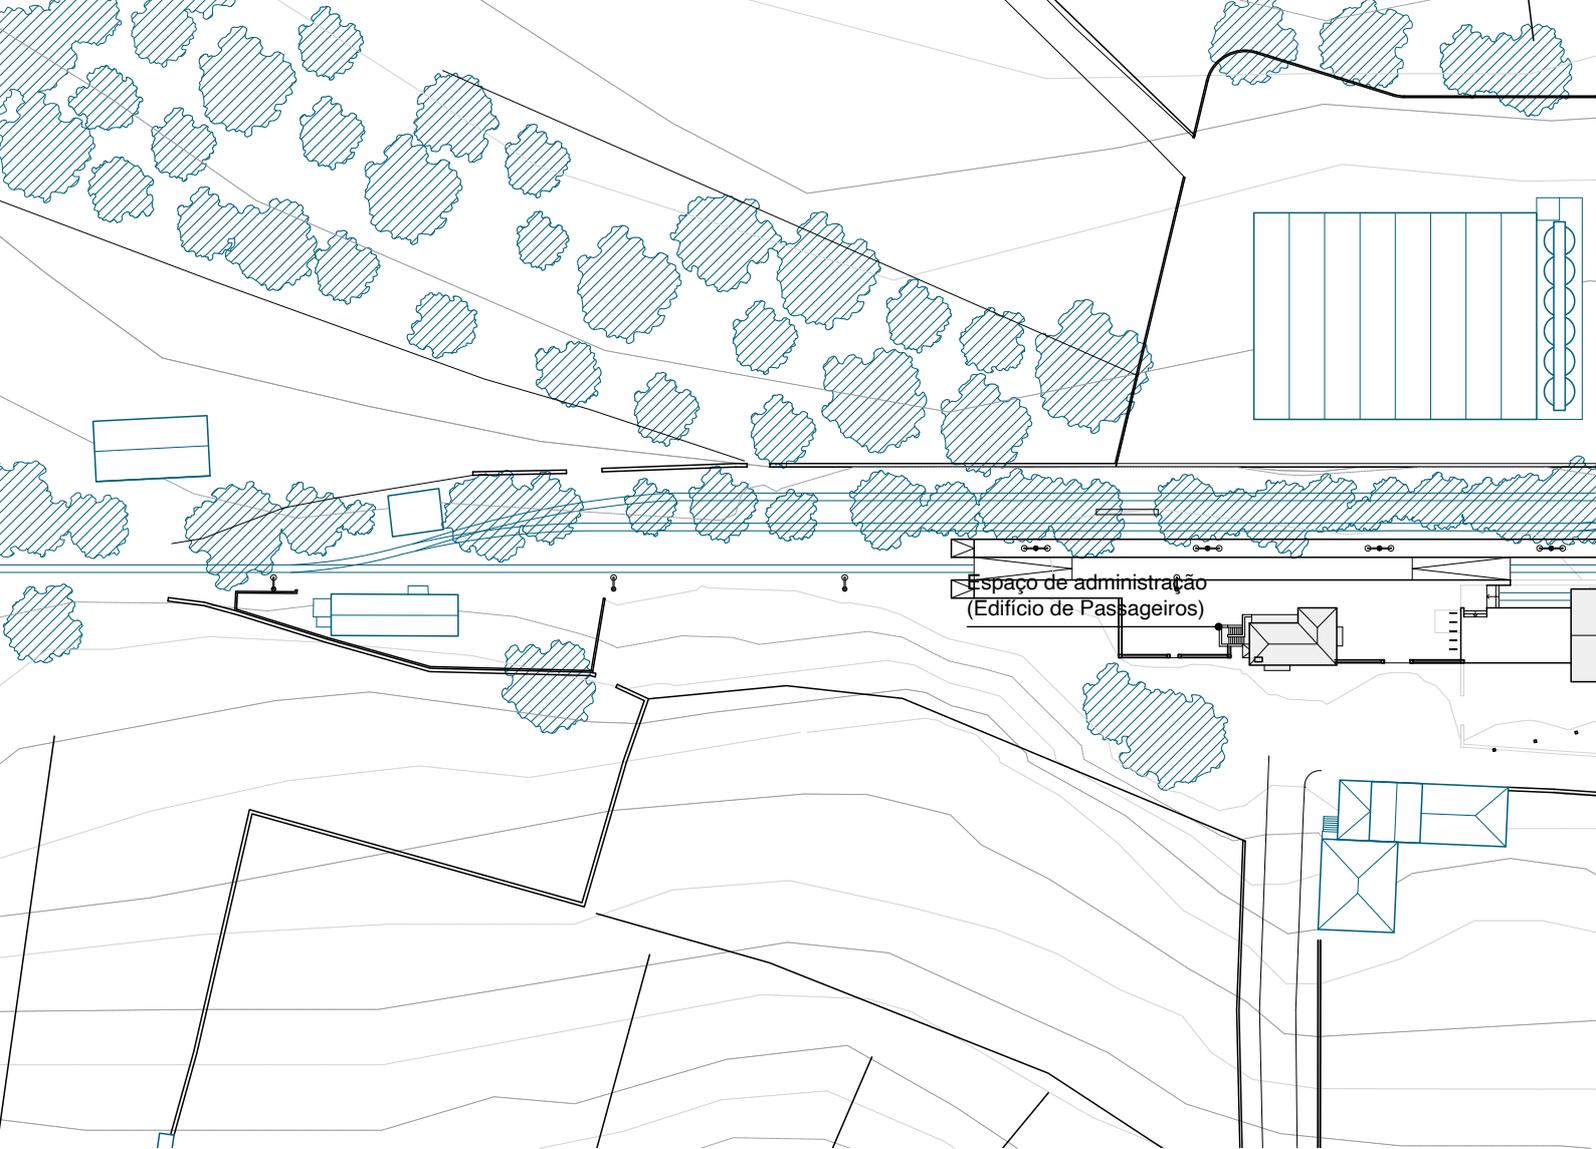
Planta da proposta da estação de Duas Igrejas-Miranda, a cinzento as estruturas intencionadas
